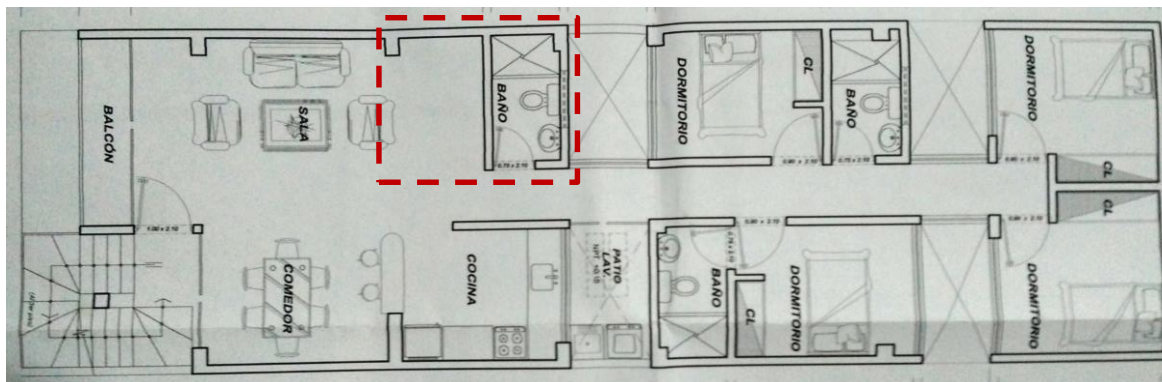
Planta del segundo Piso de la vivienda. Recuperado: Entrevista, 2017.
